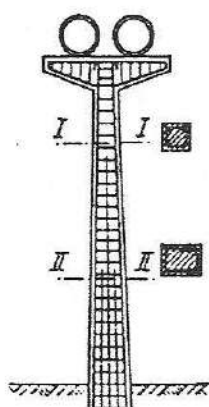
Armarea unui suport din beton armat – secțiune compusă.
